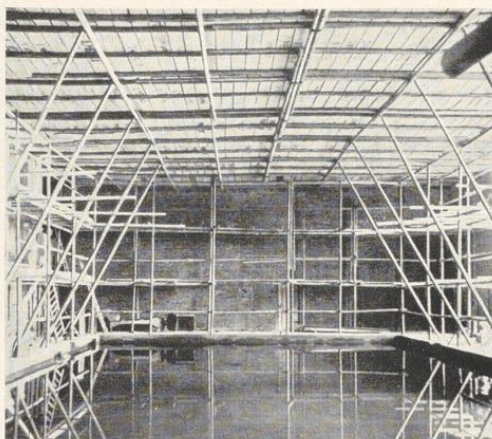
Hallenrüstung, an der Decke mit Stahlrossen aufgehängt. Ausführung Andreas Menna, Würzburg
